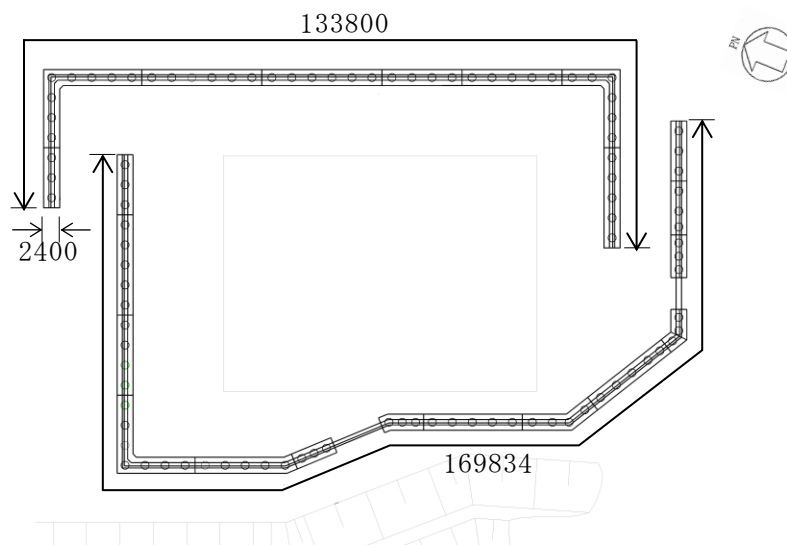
免震重要棟遮蔽壁の概要図（平面図）（単位：mm）
